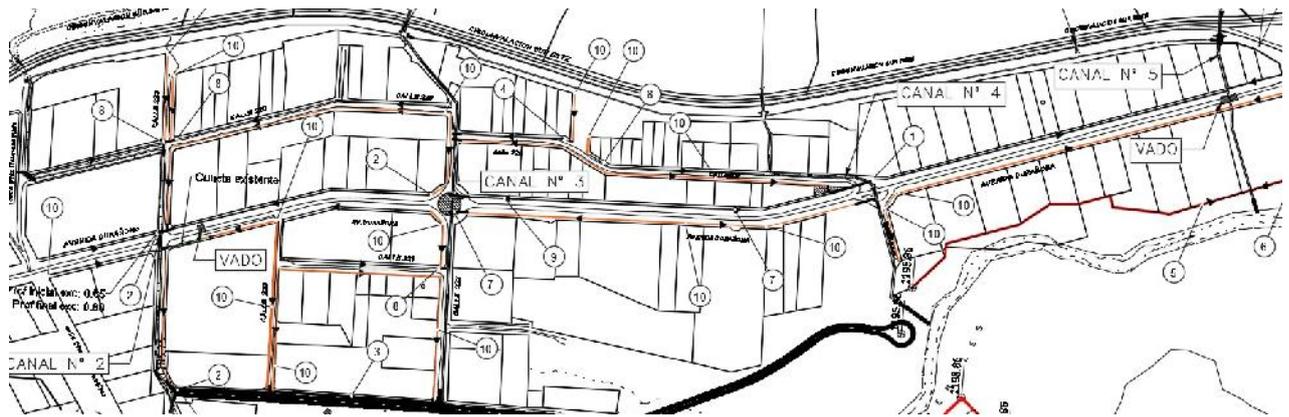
Planimetría de Red de Cunetas Proyectadas en Interior del Parque (ver plano PI-OP-002)
